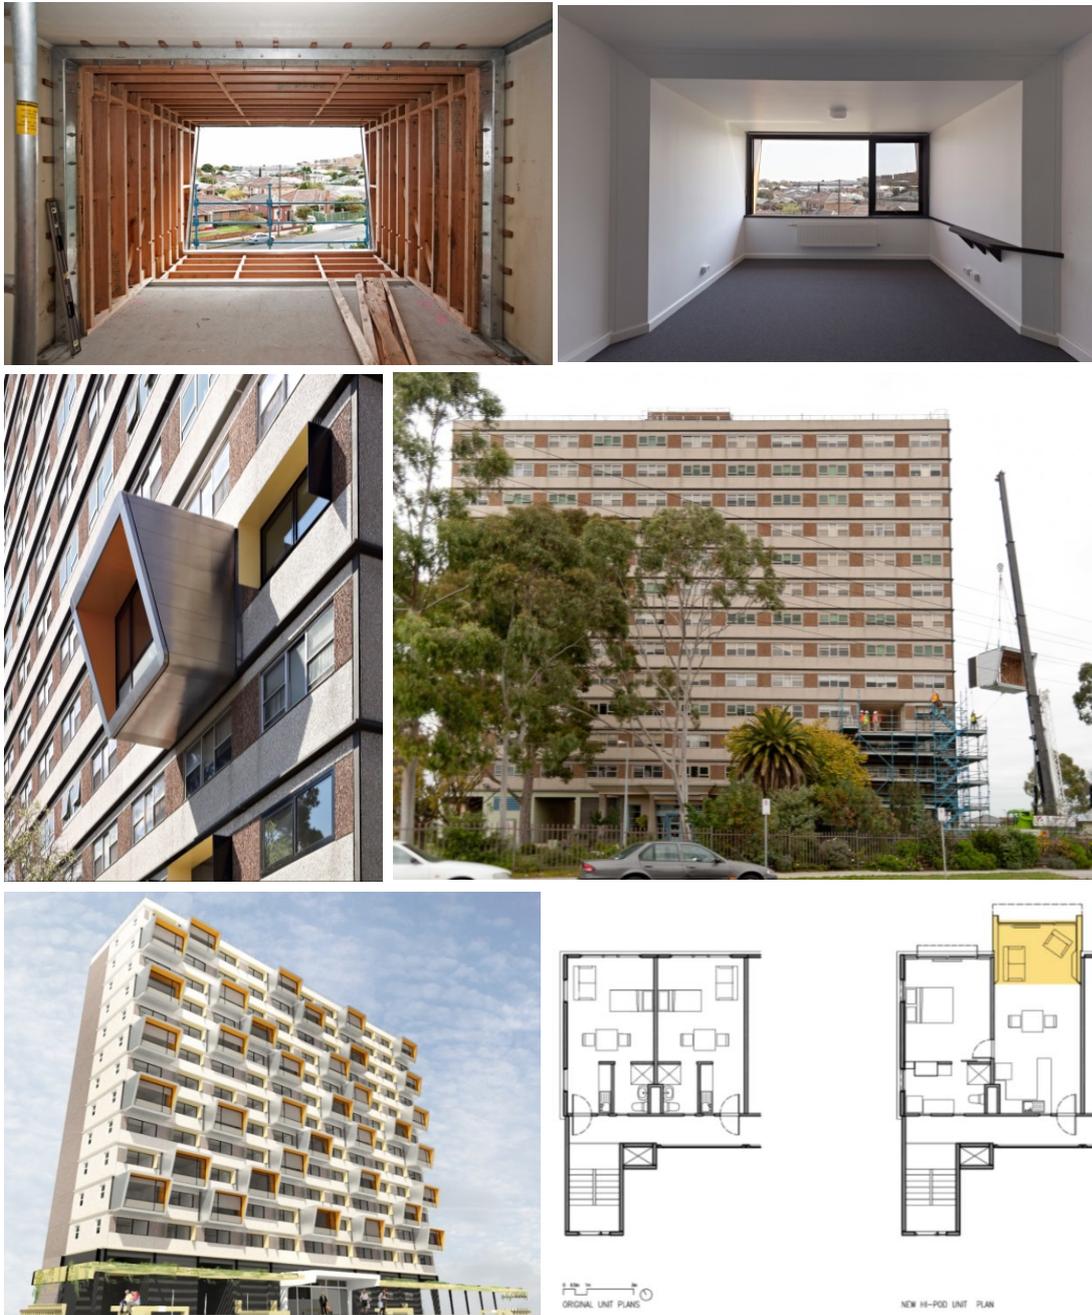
Este proyecto del 2008, localizado en Footscray Vic, Australia, actúa sobre la fachada de una torre de vivienda social y se basa en la adición de un nuevo elemento prefabricado de fácil instalación que ha sido diseñado para dotar a las viviendas de un espacio aumentando la edificabilidad de éstas. Como estrategia de diseño esta transformación busca optimizar la eficiencia energética del edificio a la vez que mejora la imagen del bloque, esperando que el cambio de imagen y su nueva presencia incida en el vecindario ayudando a impulsar un mayor sentido de comunidad de los vecinos.
